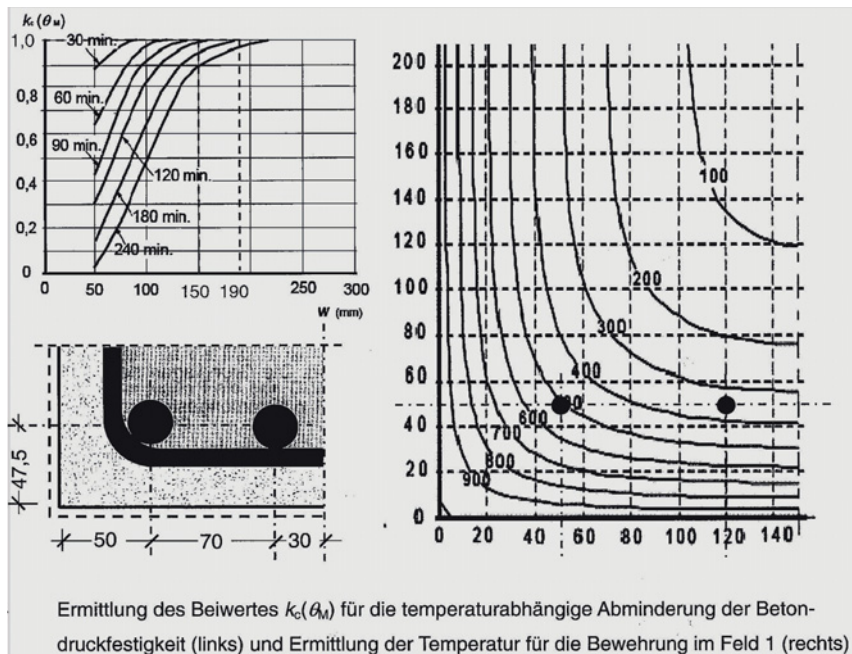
Stahlbetonbau unter Brandeinwirkungen, Temperaturanstieg im Bauteil
